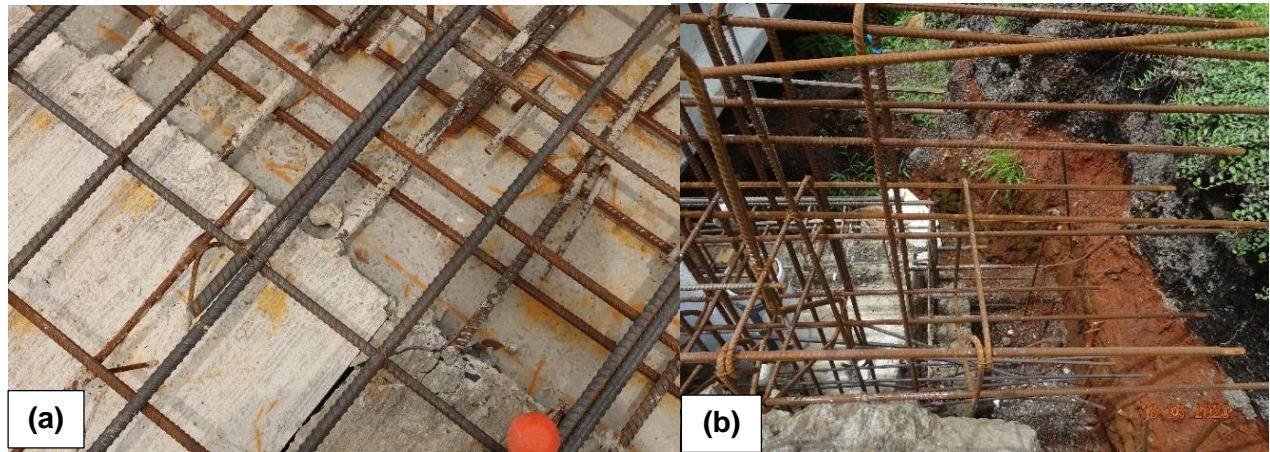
Observaciones realizadas en el puente sobre el Río San Miguel. (a) Agrietamiento y desprendimiento de material de las losetas prefabricadas del tablero de la losa. (b) Junta de construcción vertical de la viga cabezal del bastión 2 (hacia Cañas).
